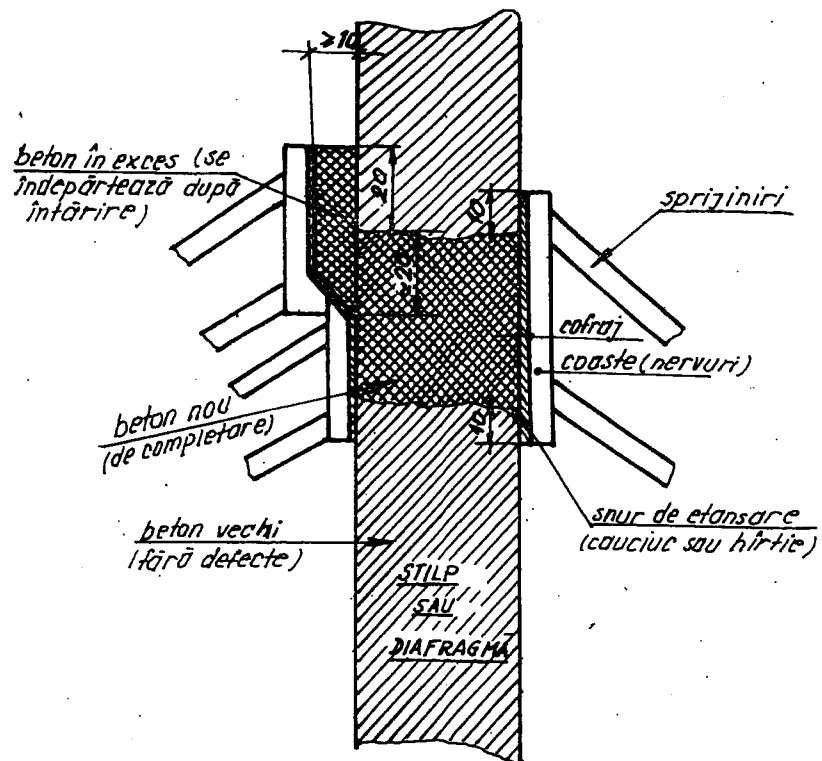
Cazul elementelor verticale (stâlpi, pereți) la care există spațiu suficient pentru manevrele de betonare și manipulare a pervibratoarelor.
